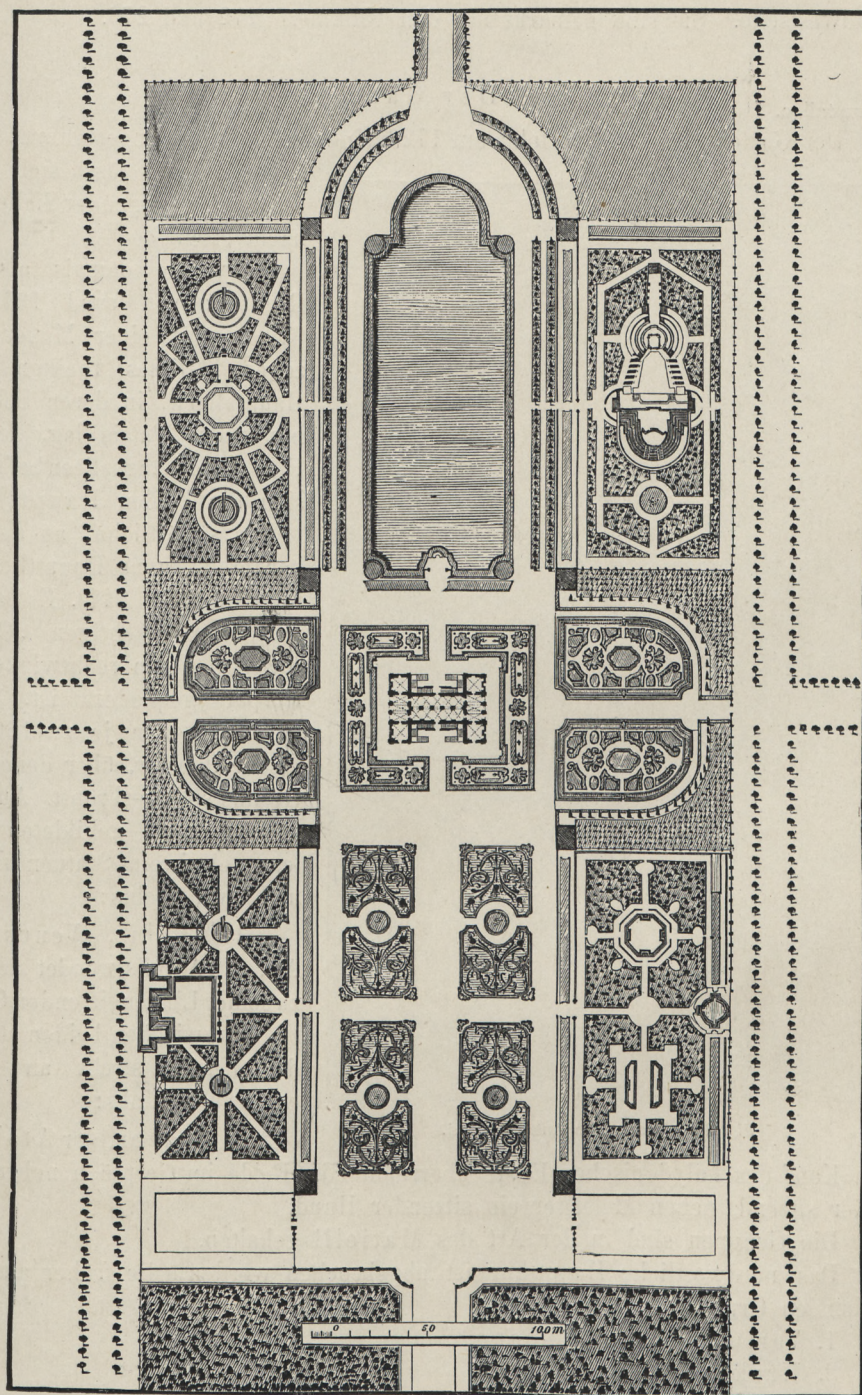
Grosser Garten, Grundriss des Mitteltheiles, Zustand nach 1720.
